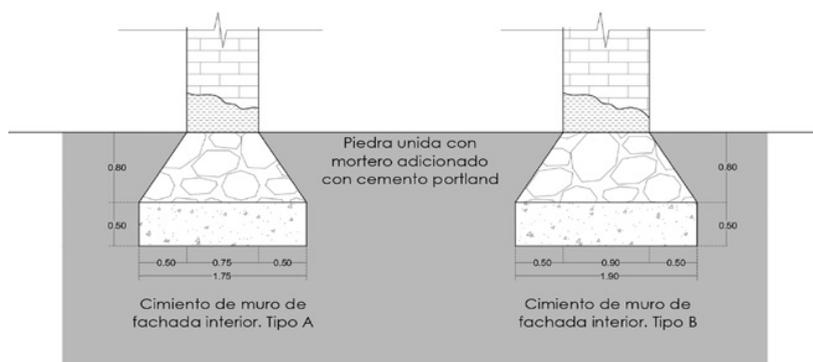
Teatro Dehesa (1902). Solución de cimientos en muros de fachada.
